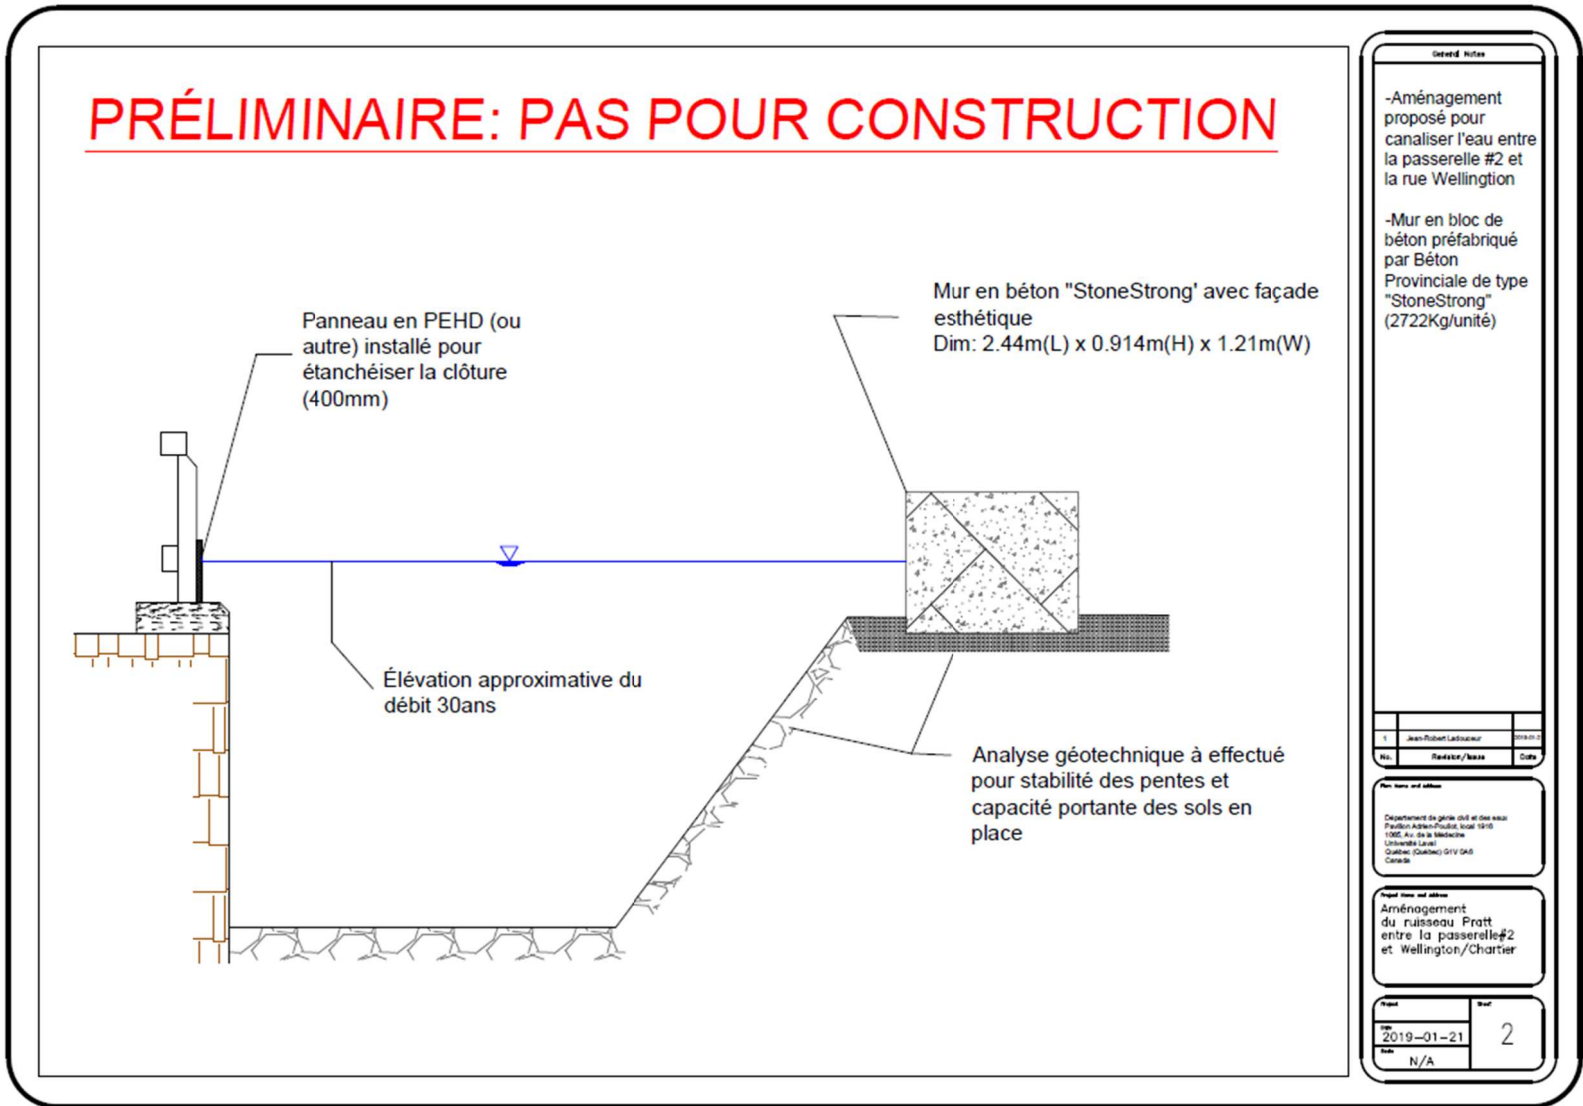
Plan d'aménagement avec mur préfabriqué et clôture étanchéisée
